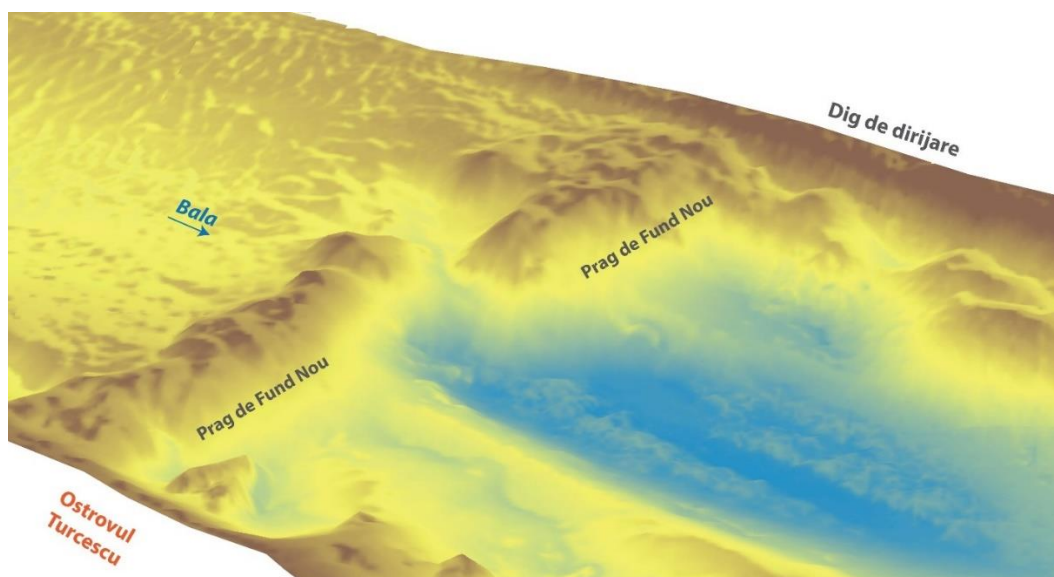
Pierderea controlului în construcția pragului de fund - Detaliu breșă (septembrie 2013)
